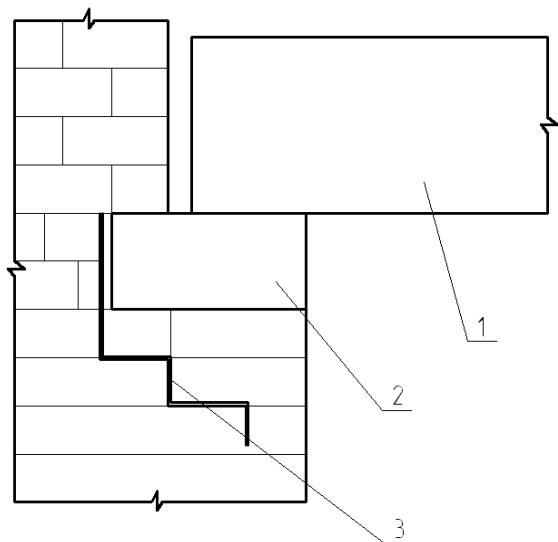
Схема руйнування кам'яної кладки під опорною подушкою:
